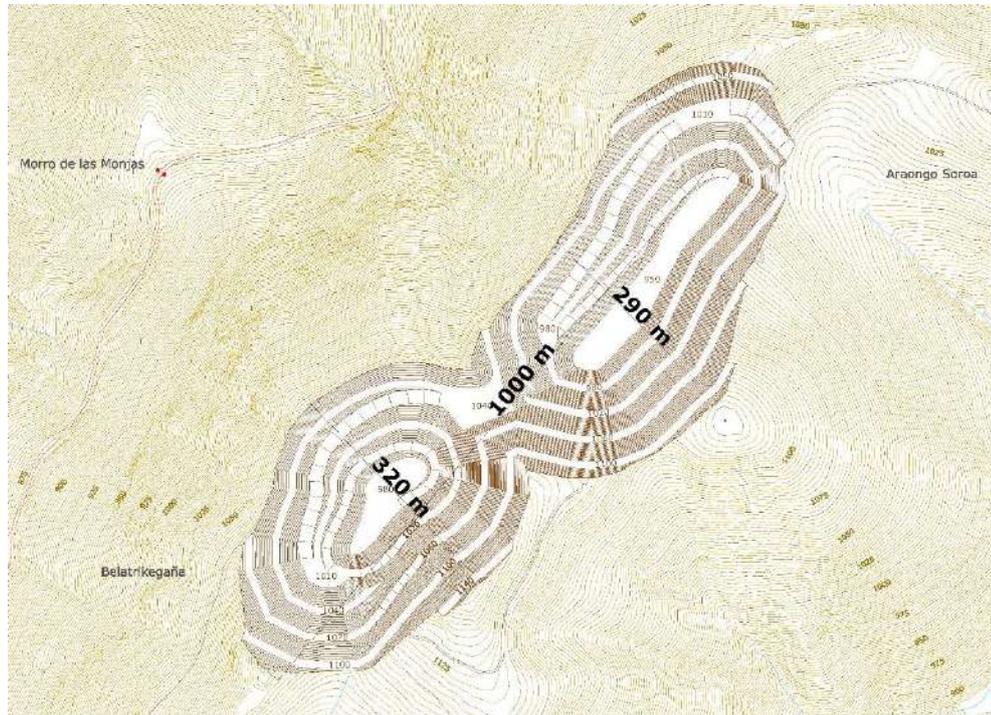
Vista en planta del conjunto de ambas cortas
